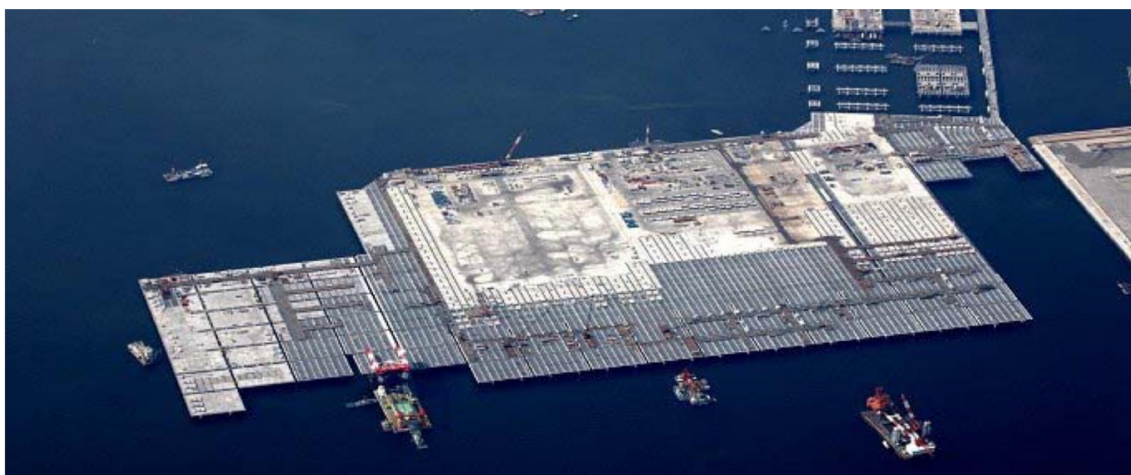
Vista aérea da construção da estrutura do aeroporto de Haneda – Japão.
